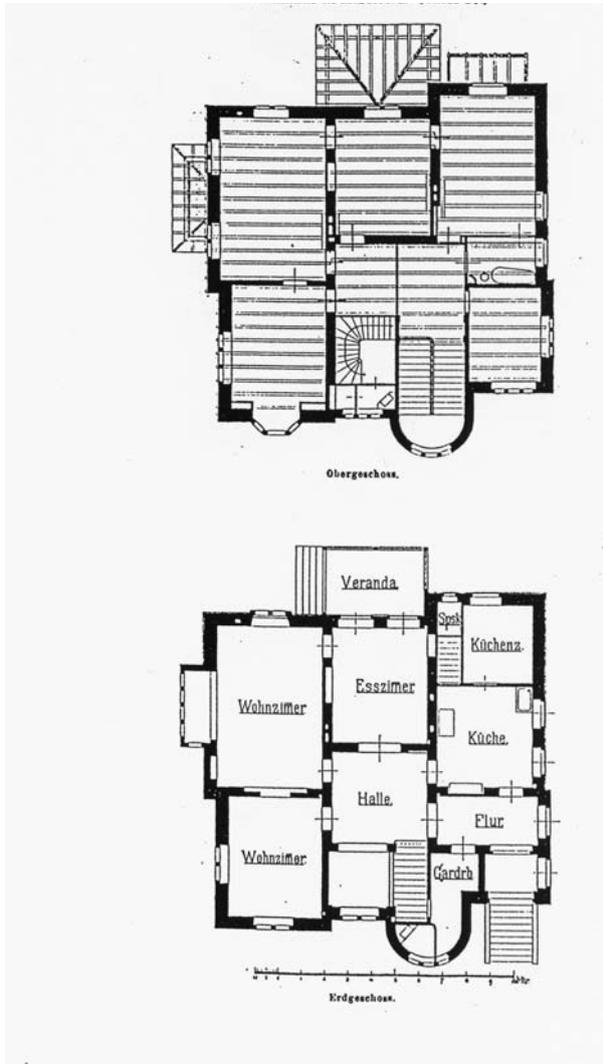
Haus Viktoriastraße 30, Grundrisse Erdgeschoss (unten) und Obergeschoss, 1894
